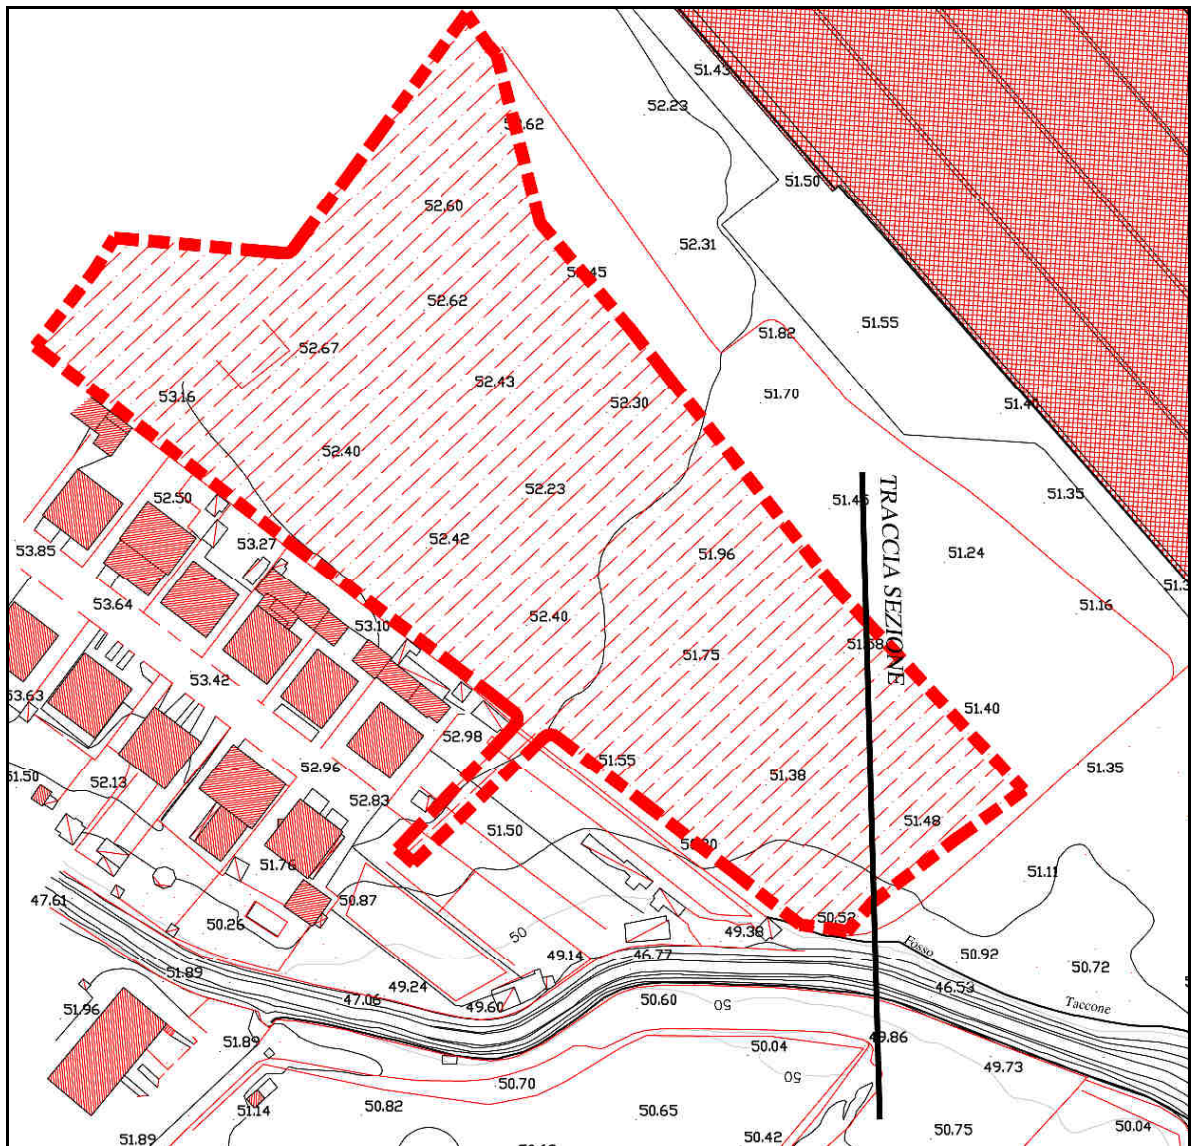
Perimetro area in variante e traccia della sezione eseguita su rilievo LIDAR 2011
